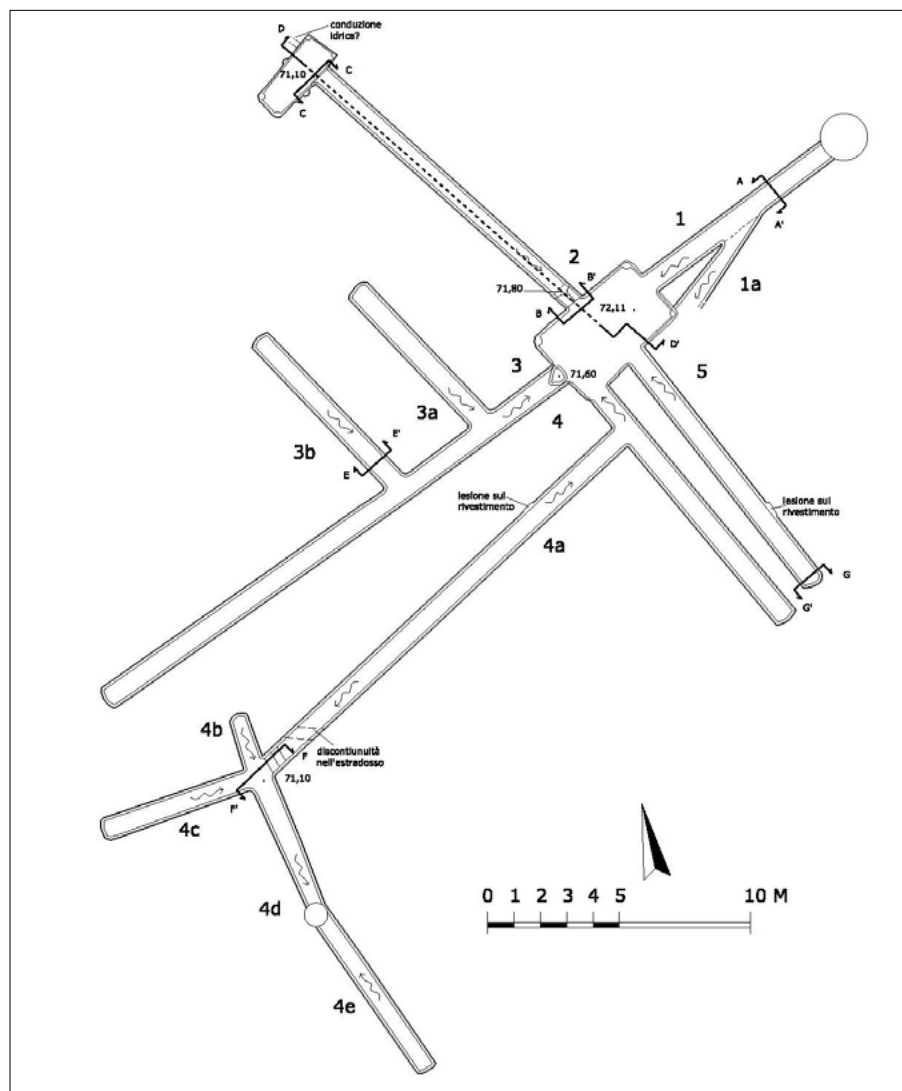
Pianta cisterna a pettine (rilievo e disegno D.I. Pellandra)
